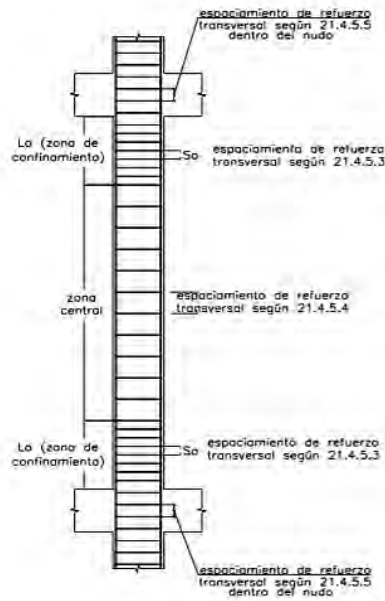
Disposiciones para el diseño sísmico por corte en las columnas.
